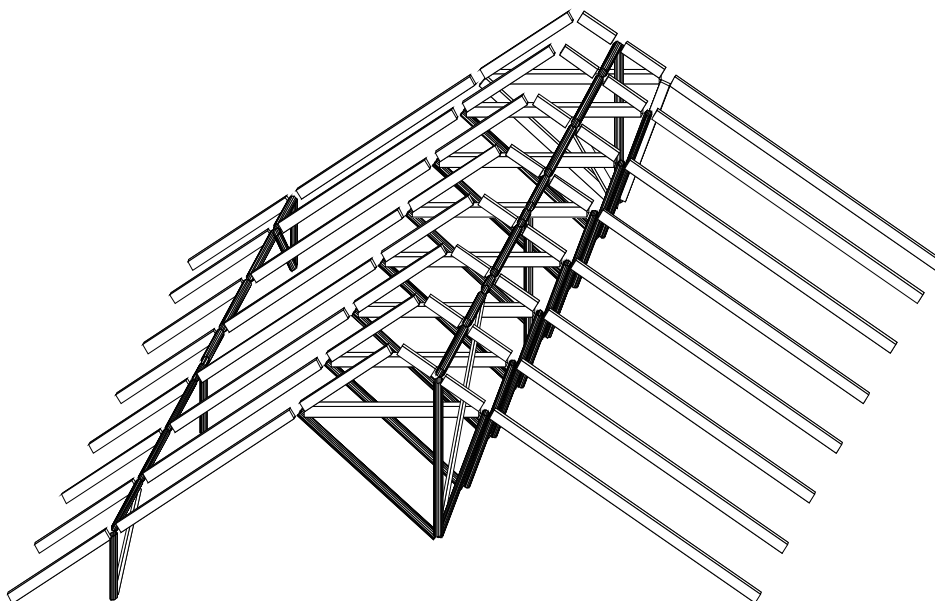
Общий вид фрагмента стропильной системы в осях 2...5 (со схематичным обозначением поперечных сечений).
